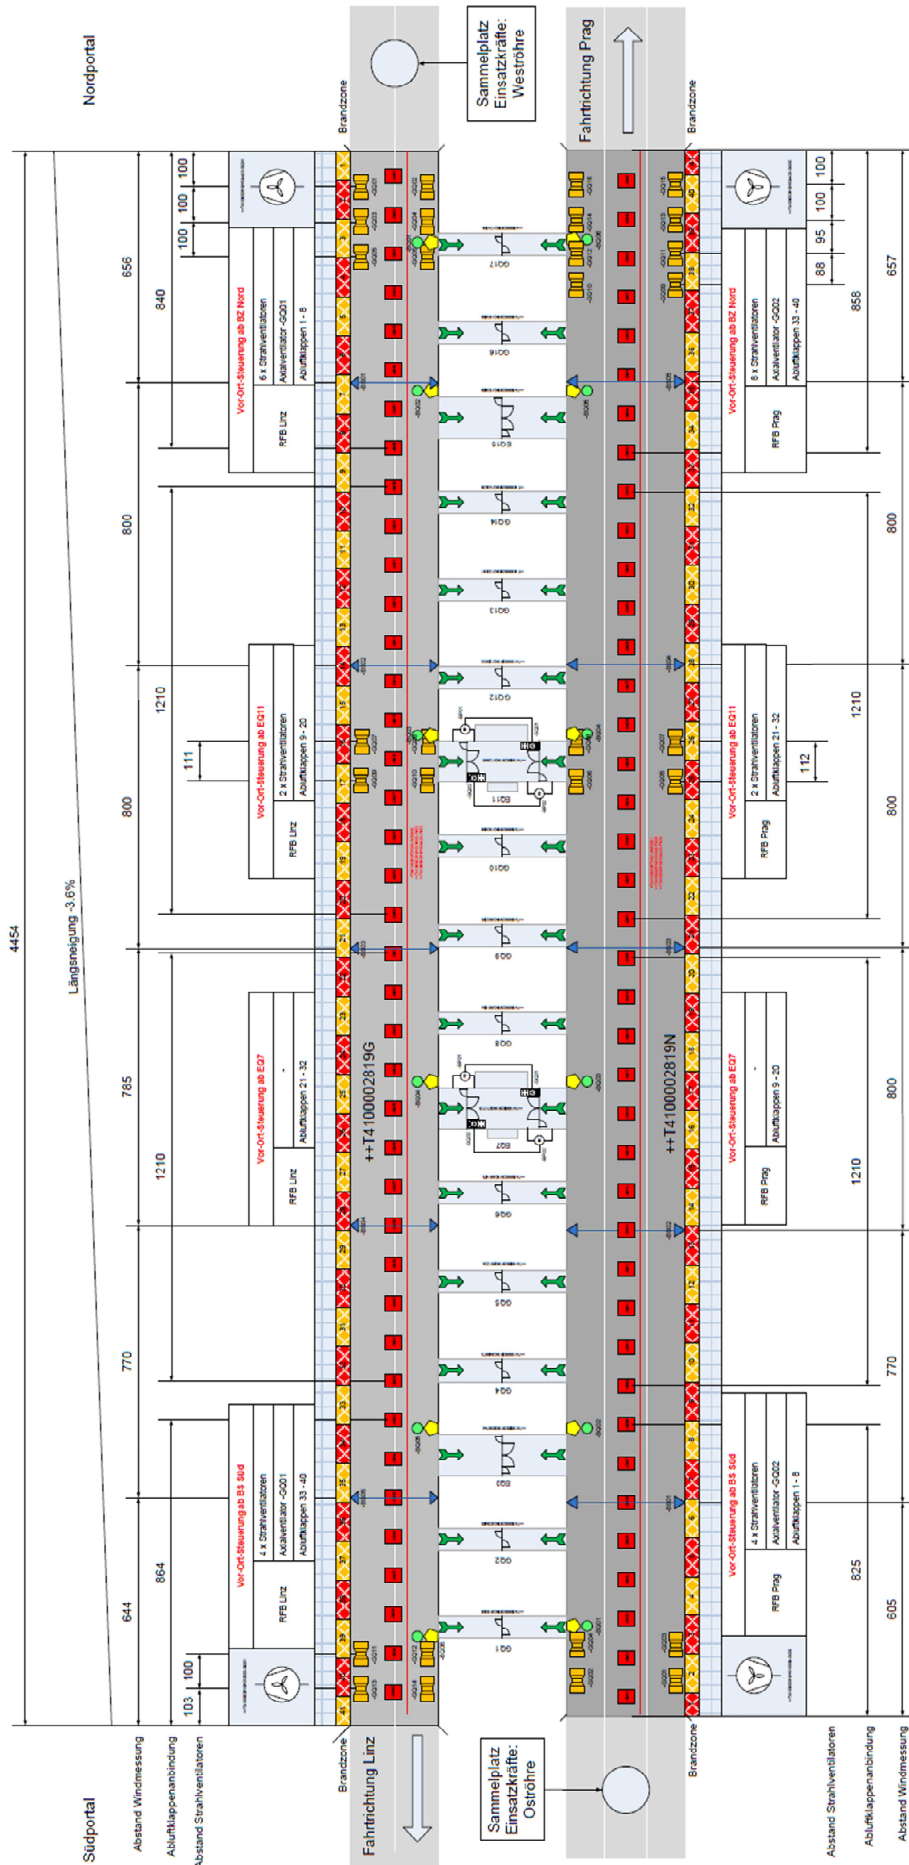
Grundriss Götschka Tunnel mit lüftungstechnischen Komponenten
